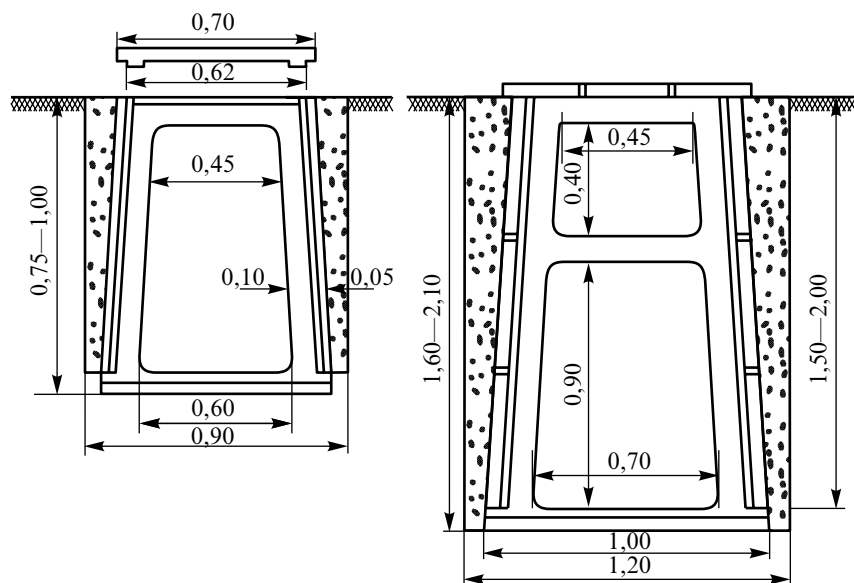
Железобетонные лотки рамного типа (размеры в м)
